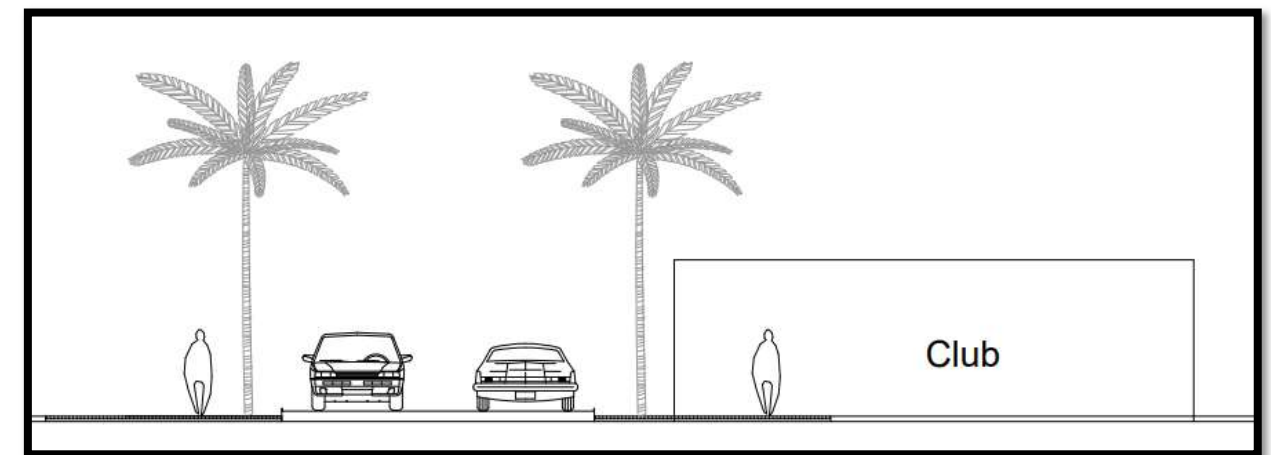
Sección transversal tramo 2. Fuente: Elaboración propia.
